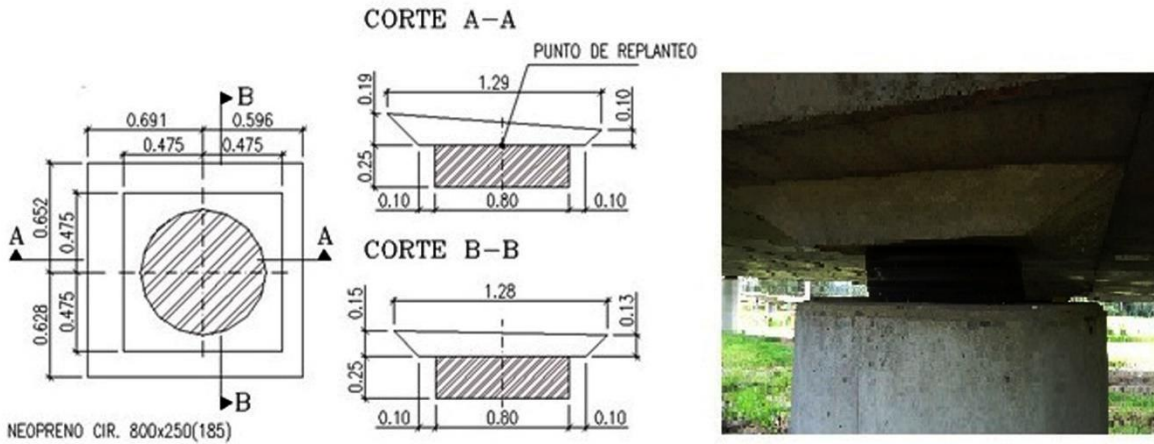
Esquema de apoyos en pilas. Fuente: tomado de planos de construcción, cortesía Pedelta Colombia S.A.S.
